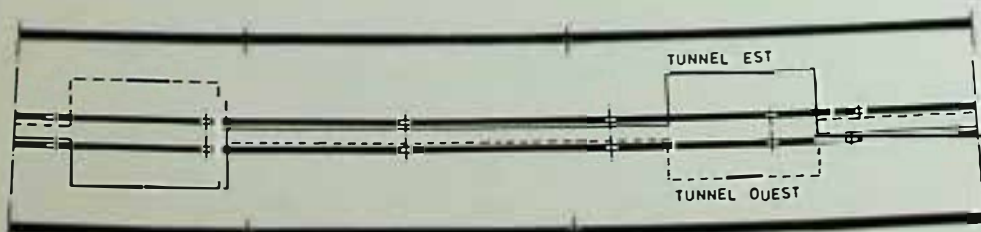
Coupe longitudinale d'une partie du tunnel
